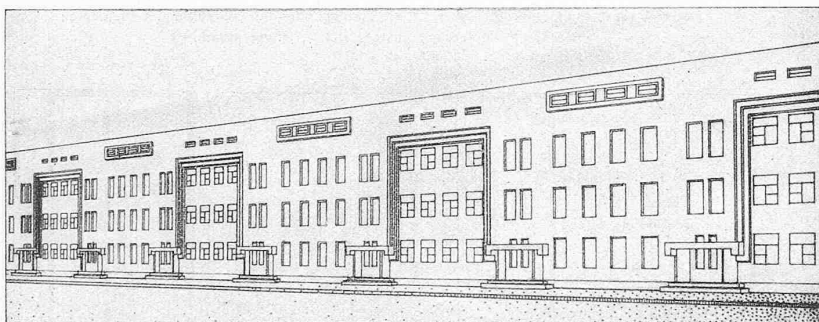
Strasse mit Volkswohnungen, Entwurf Arch. J. J. P. Oud, Rotterdam.
